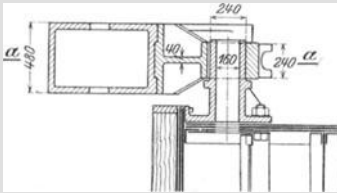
a u. b. Halslager und Anschlag der Scheitniger Schleuse bei Breslau. In zwei Schnitten. Maßstab 1 : 24.
